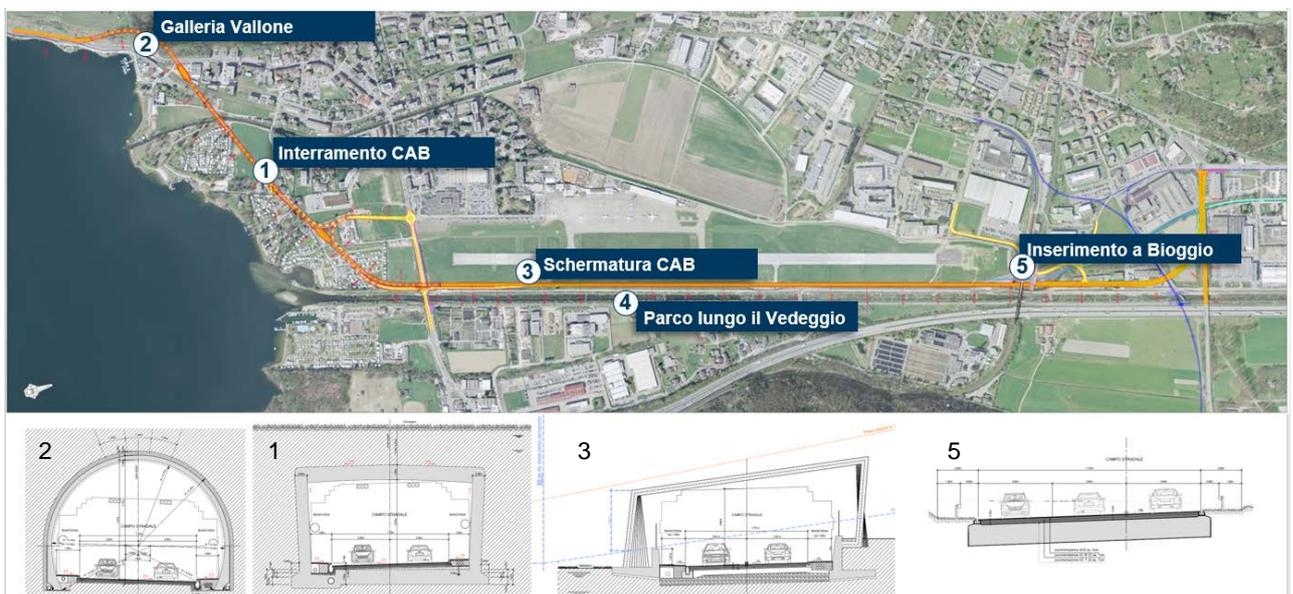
Planimetria e sezioni tipo del Progetto di massima 2019 Variante C
